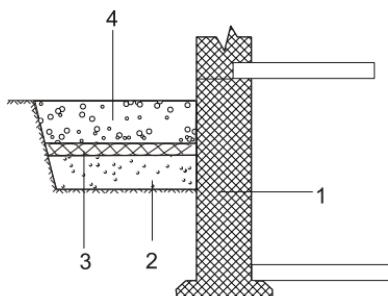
Защита грунта от промерзания в сочетании с утеплением подвальных помещений: 1 — стена подвала; 2 — песчаная подсыпка толщиной 200 мм; 3 — экструдированный пенополистирол; 4 — песчано-гравийная засыпка толщиной 300 мм
